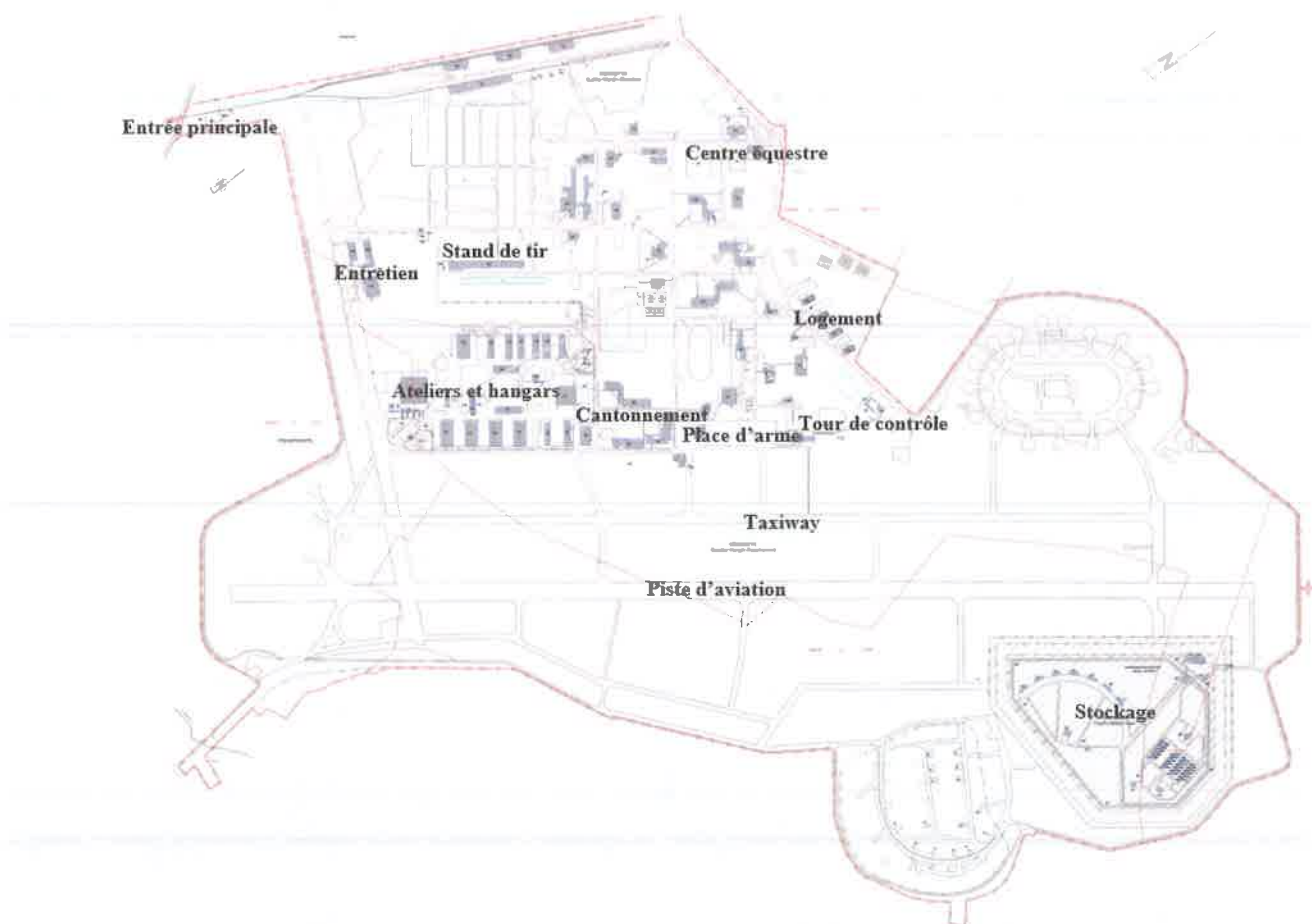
Plan du site avec repérage des routes, pistes et bâtiments
